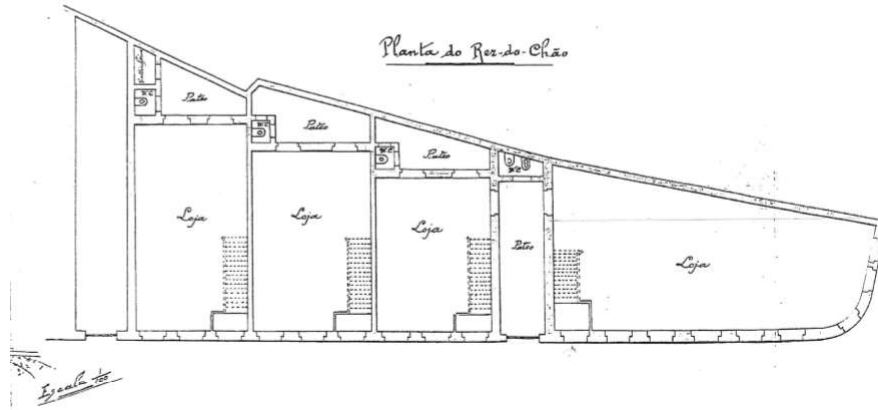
Planta do R/c; Primeiras plantas da construção datadas do final do século XVIII
